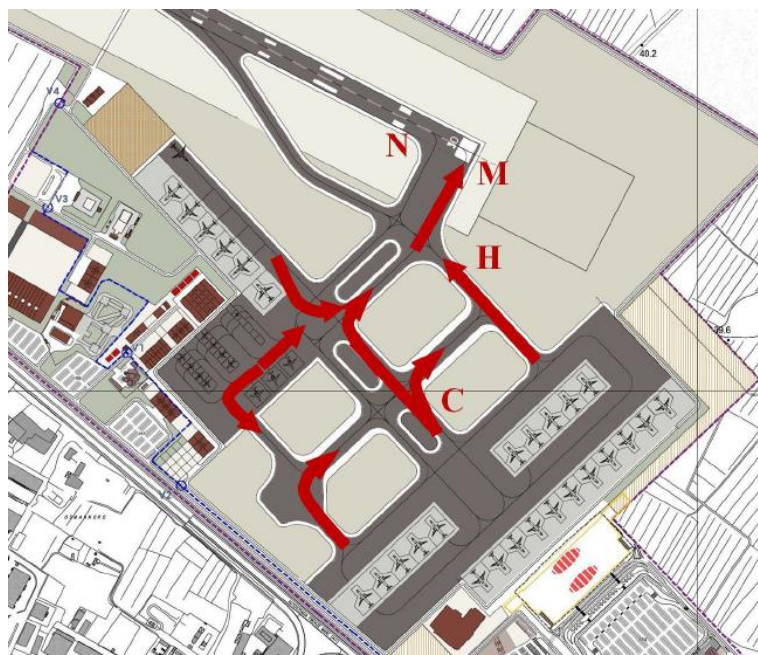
Raccordi di servizio e collegamento pista – Apron. Percorsi di rullaggio verso la pista
